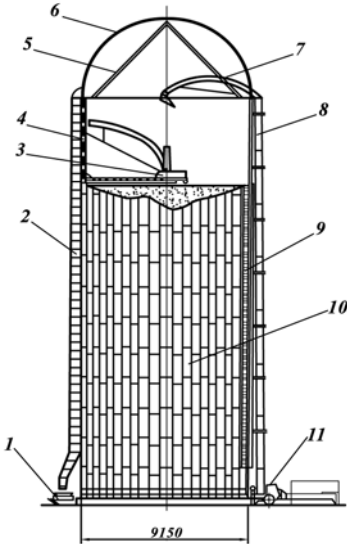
Сінажна башта із бетонних блоків:
